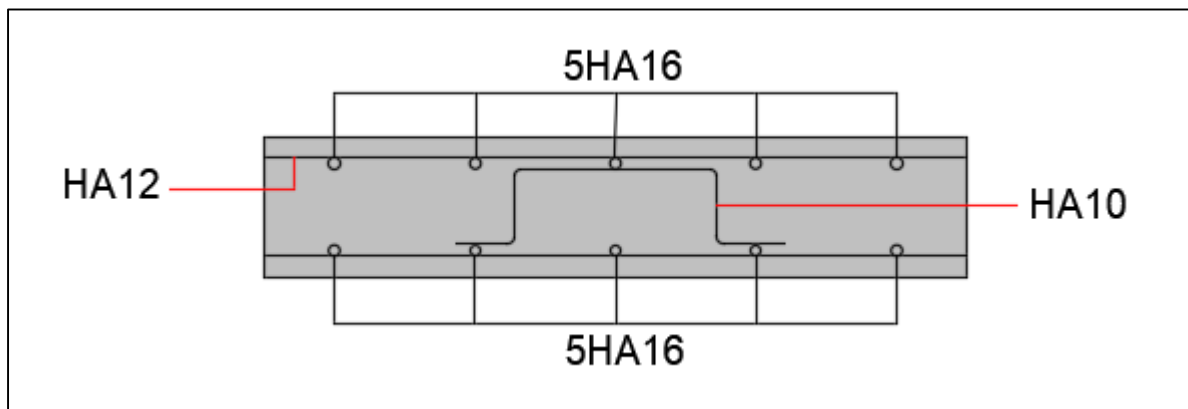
Figure VIII-X Ferrailage de la dalle (coupe transversale)
